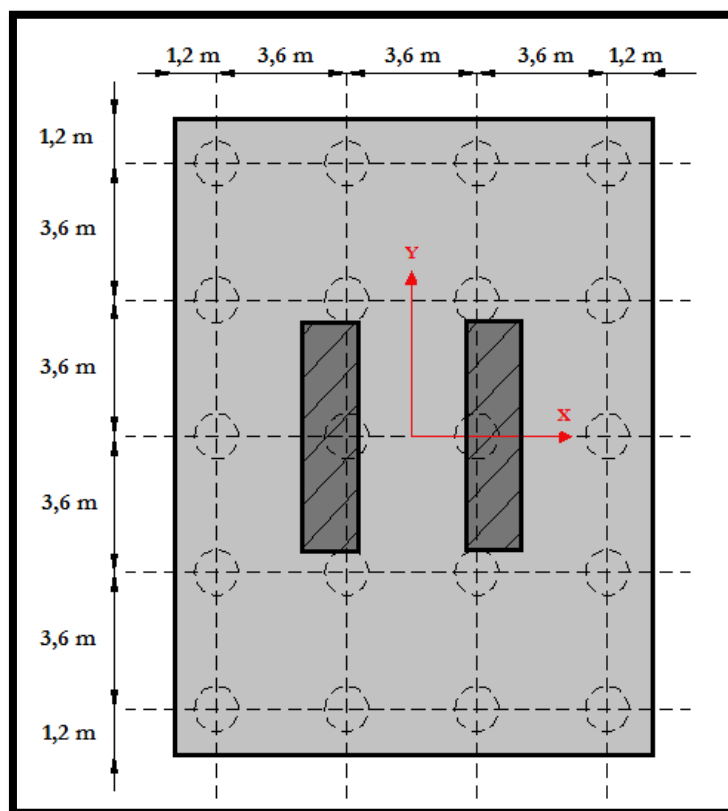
Disposition des pieux au niveau des piles (vue en plan).
